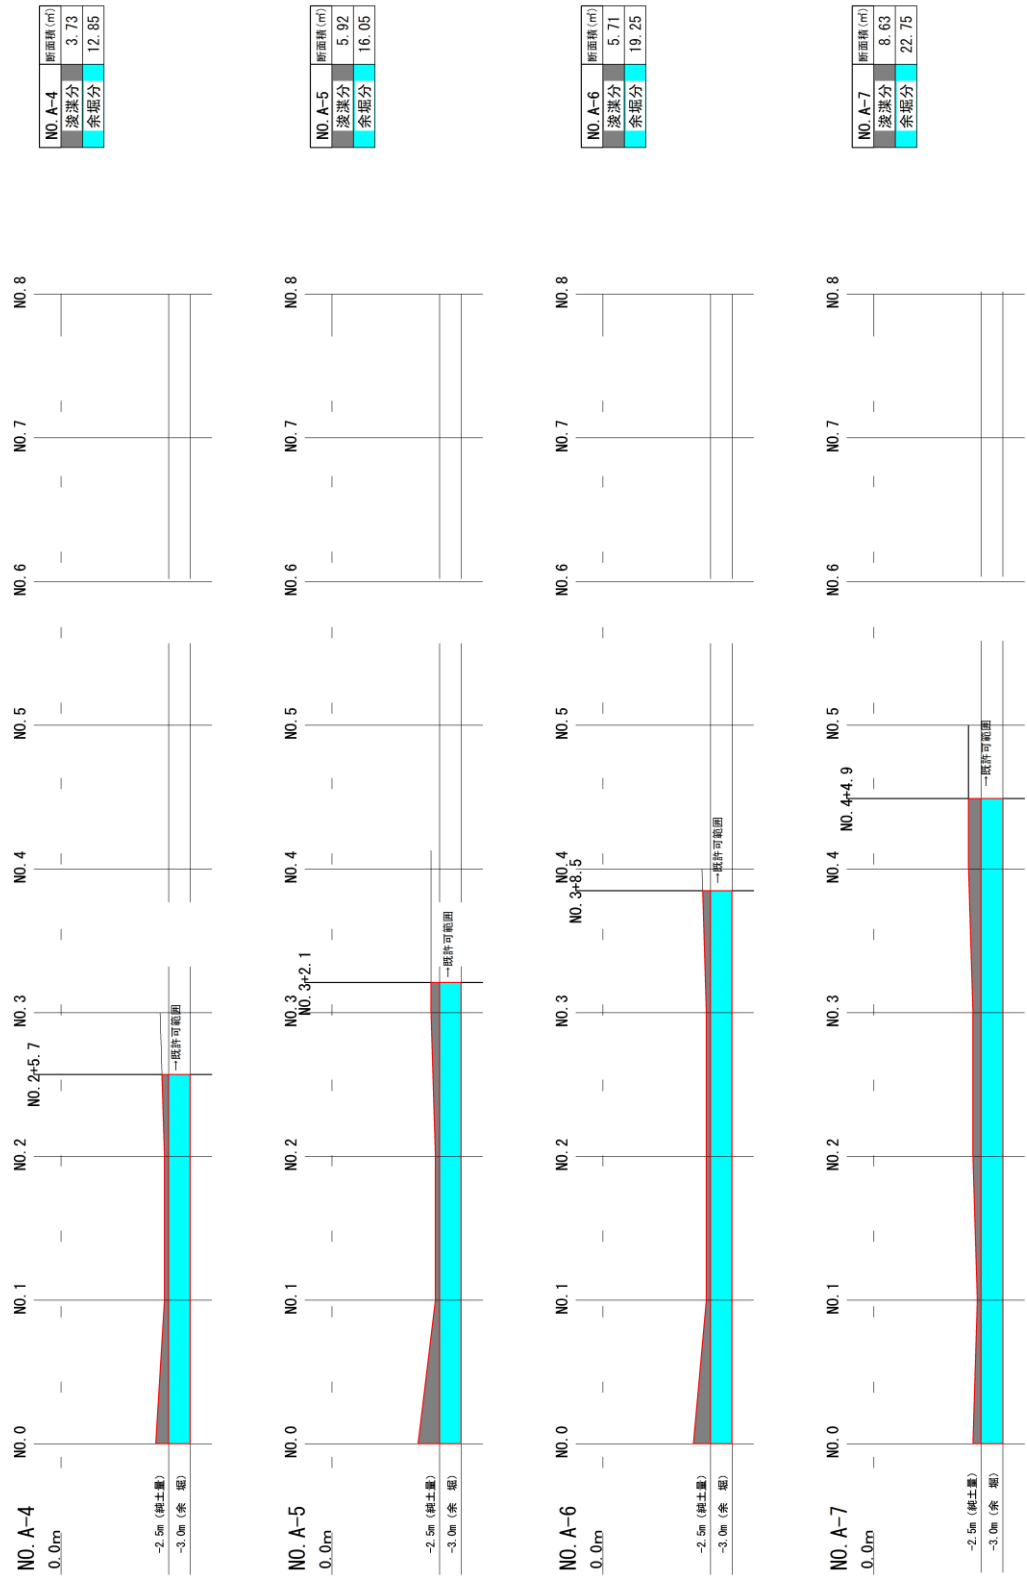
(2) 横断面 (測線 No. A-4~A-7)
